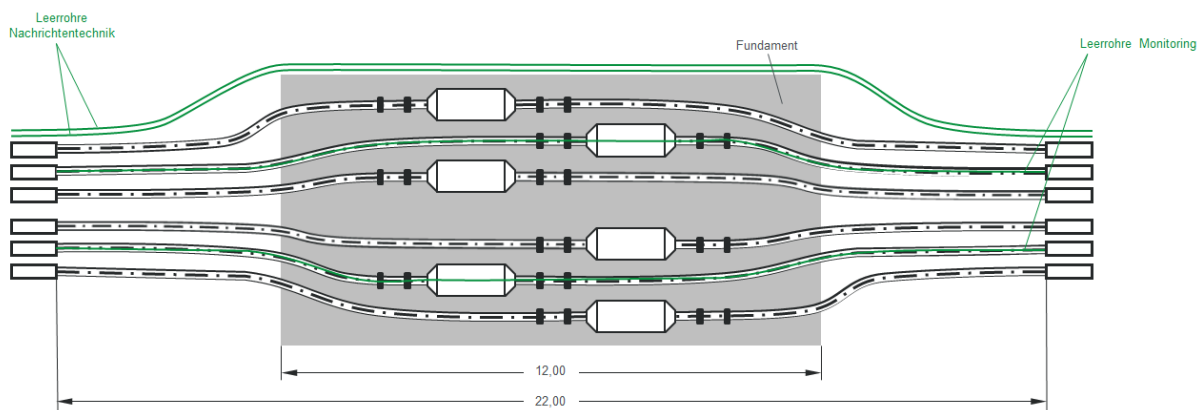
Muffengrube für Teilverkabelungsabschnitt, Draufsicht
